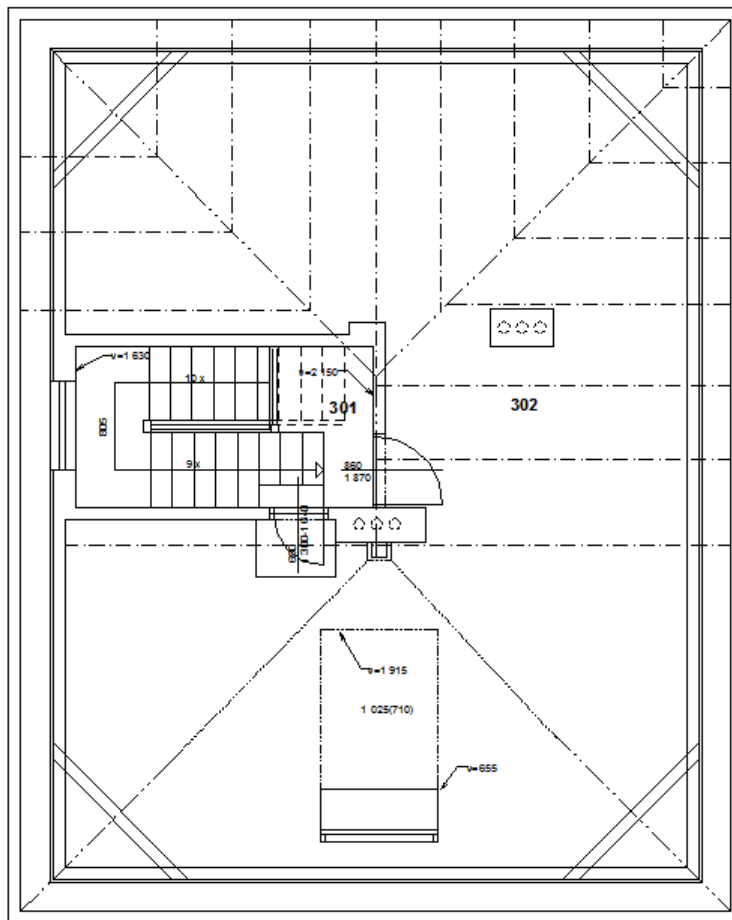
zjednodušený půdorys 2. patra po rekonstrukci
